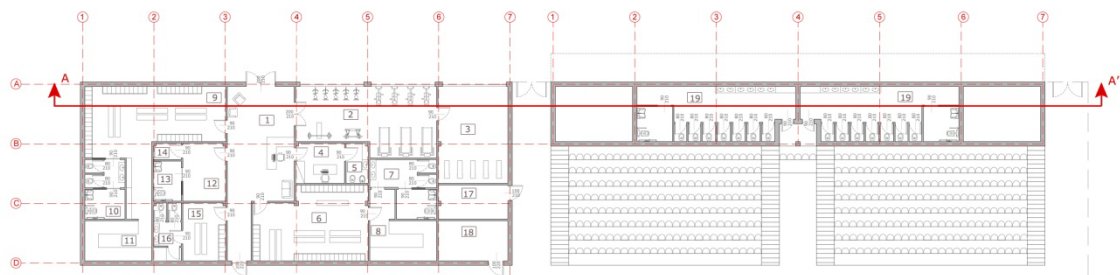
Pianta del centro sportivo e tribuna, stralcio della tavola 5.17, *Piante centro sportivo e parcheggio*. Fonte. Elaborazione grafica dell'autore.
